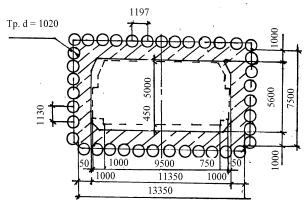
Схема тоннеля прямоугольного очертания с замкнутым контуром
